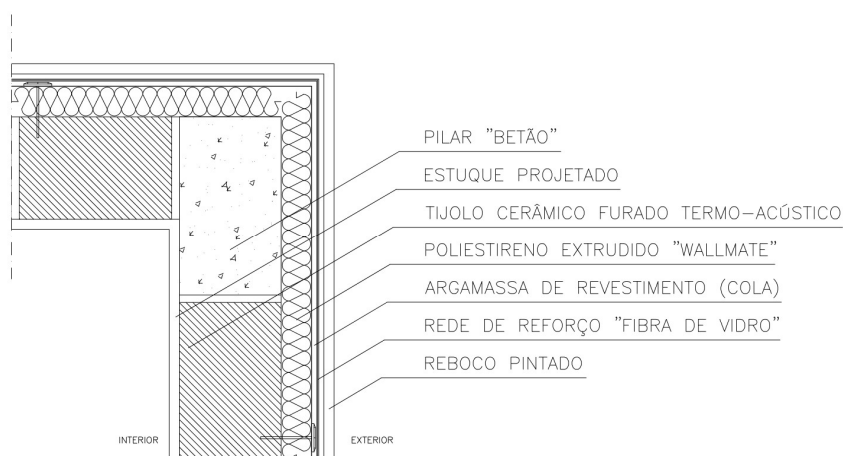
Demonstração da constituição da ponte térmica plana PPE1
